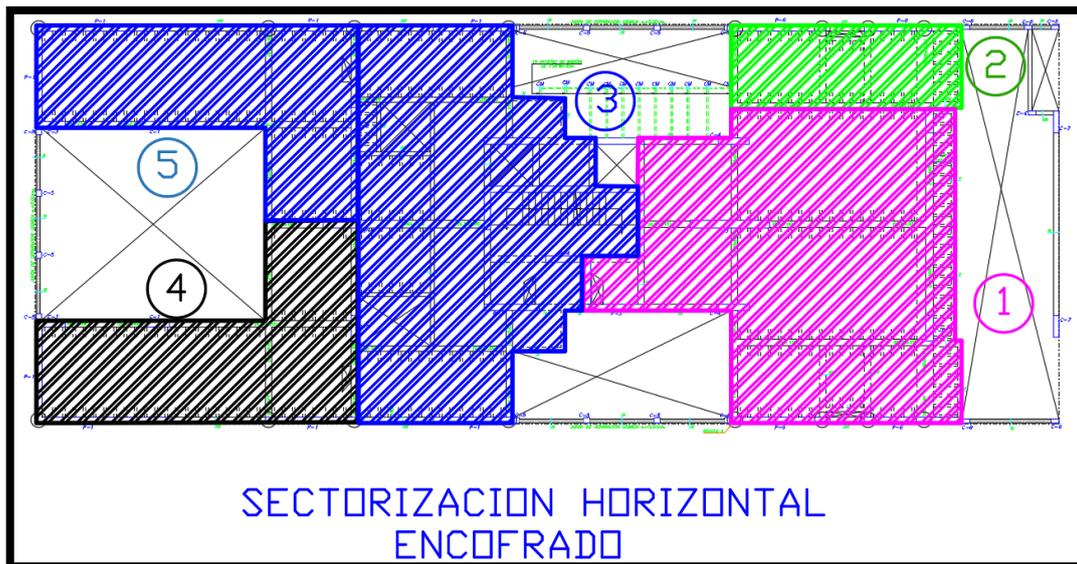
Sectorización de Elementos Horizontales para encofrado – Piso 2 al Piso 10.
